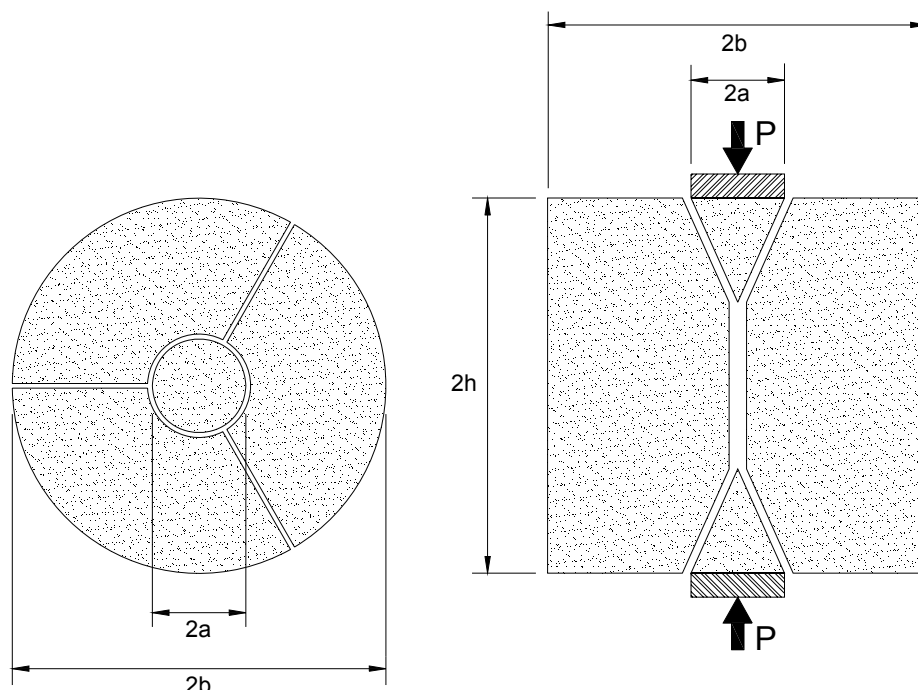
Mecanismo idealizado de rotura en el que se puede observar una vista en planta y un corte longitudinal.
